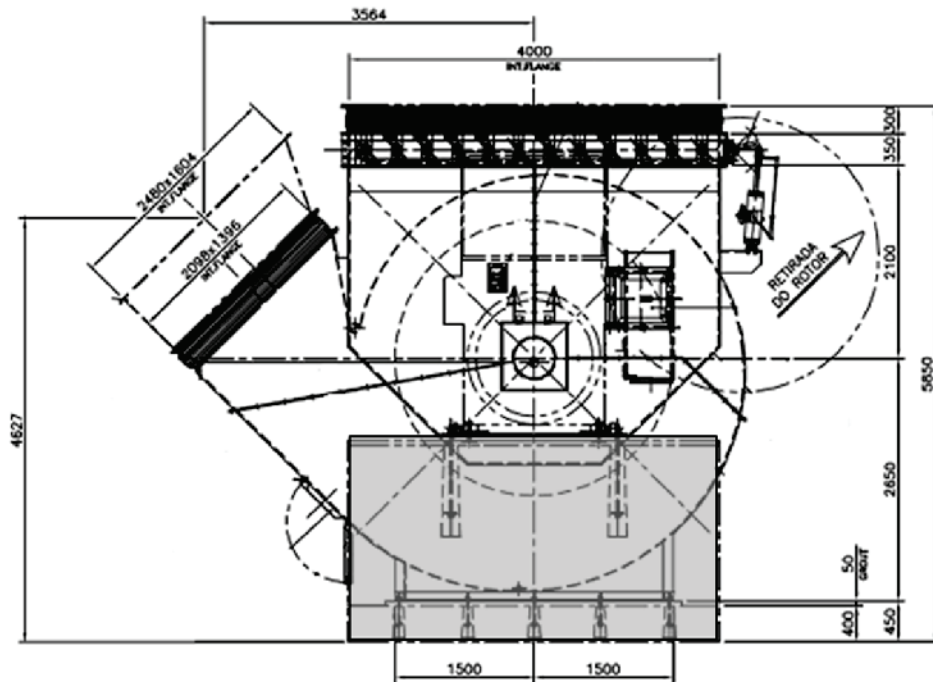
Corte longitudinal pelo eixo do soprador mostrando os pontos de fixação do equipamento no bloco de concreto da fundação
